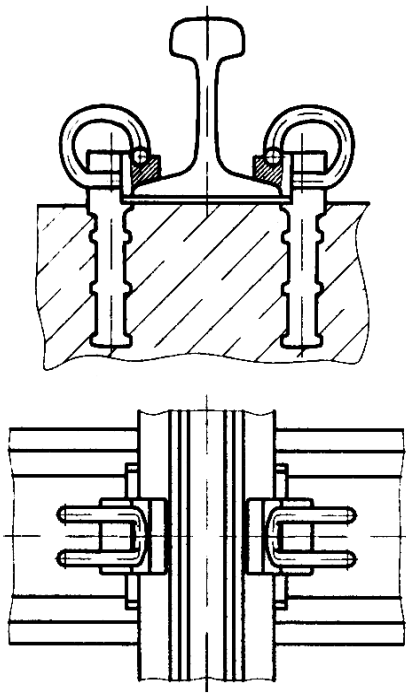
Нероздільне безболтове скріплення типу КПП-1
